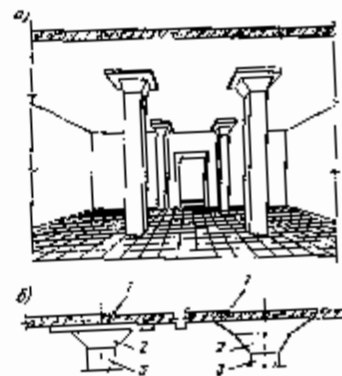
Железобетонное монолитное безбалочное перекрытие: а - общий вид; б – схема опирания плиты на колонну; 1 – плита; 2 – капитель; 3 – колонна.
